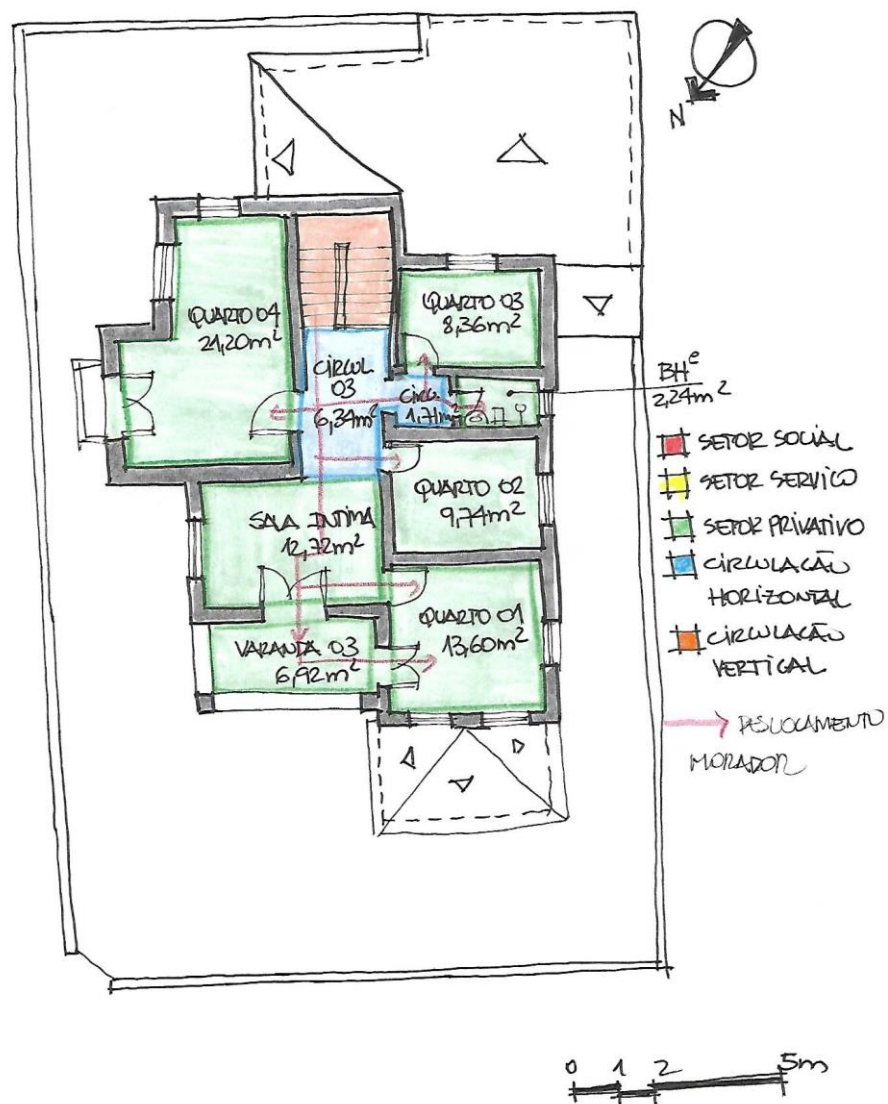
Planta do pavimento superior da Residência Nº 480. Fonte: autora, 2019.
